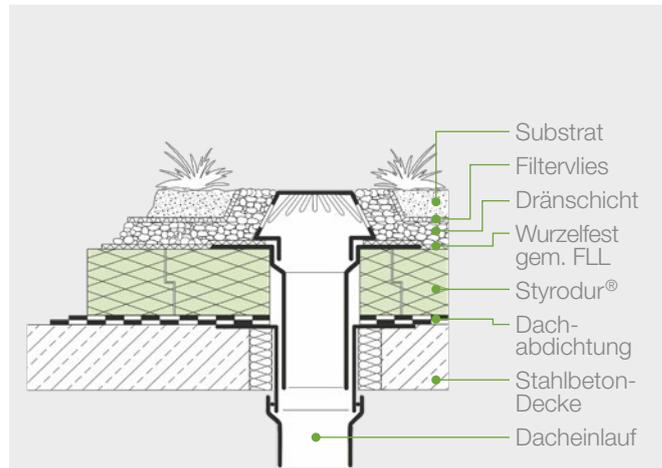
Dacheinlauf eines UK-Gründaches mit einer Sickerschicht aus Kies.
